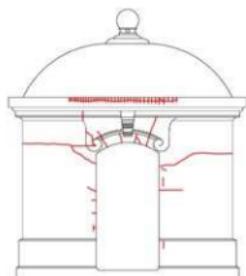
制水井5号上屋 補修図 ■ 断面修復 ── 鉄骨補足 ————— ひび割れ注入 (幅0.2mm以上かつひび割れ内部がエプロレッセンスで詰まっていない箇所)
